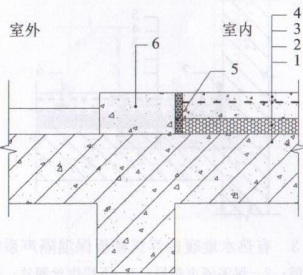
浮筑楼板与室外楼地面交接处构造 (剖面图)
